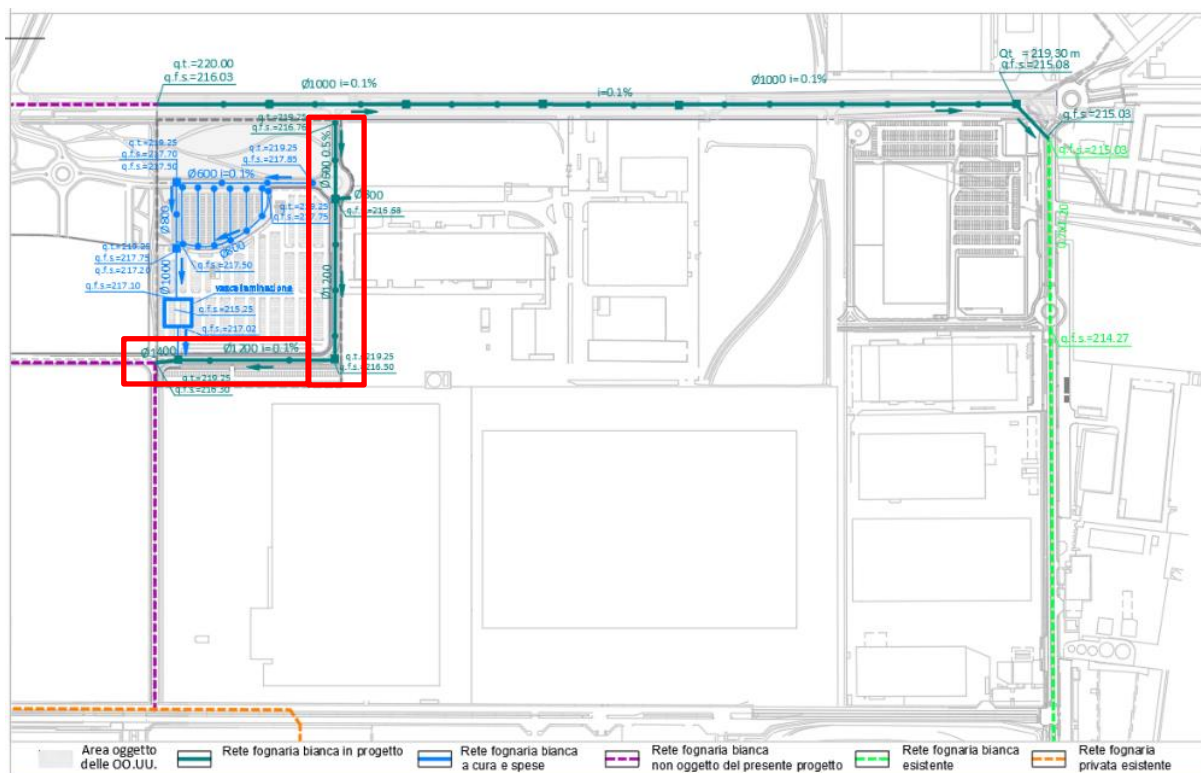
Planimetria acque meteoriche in progetto con evidenziazione degli interventi sulle aree interne a scampo
